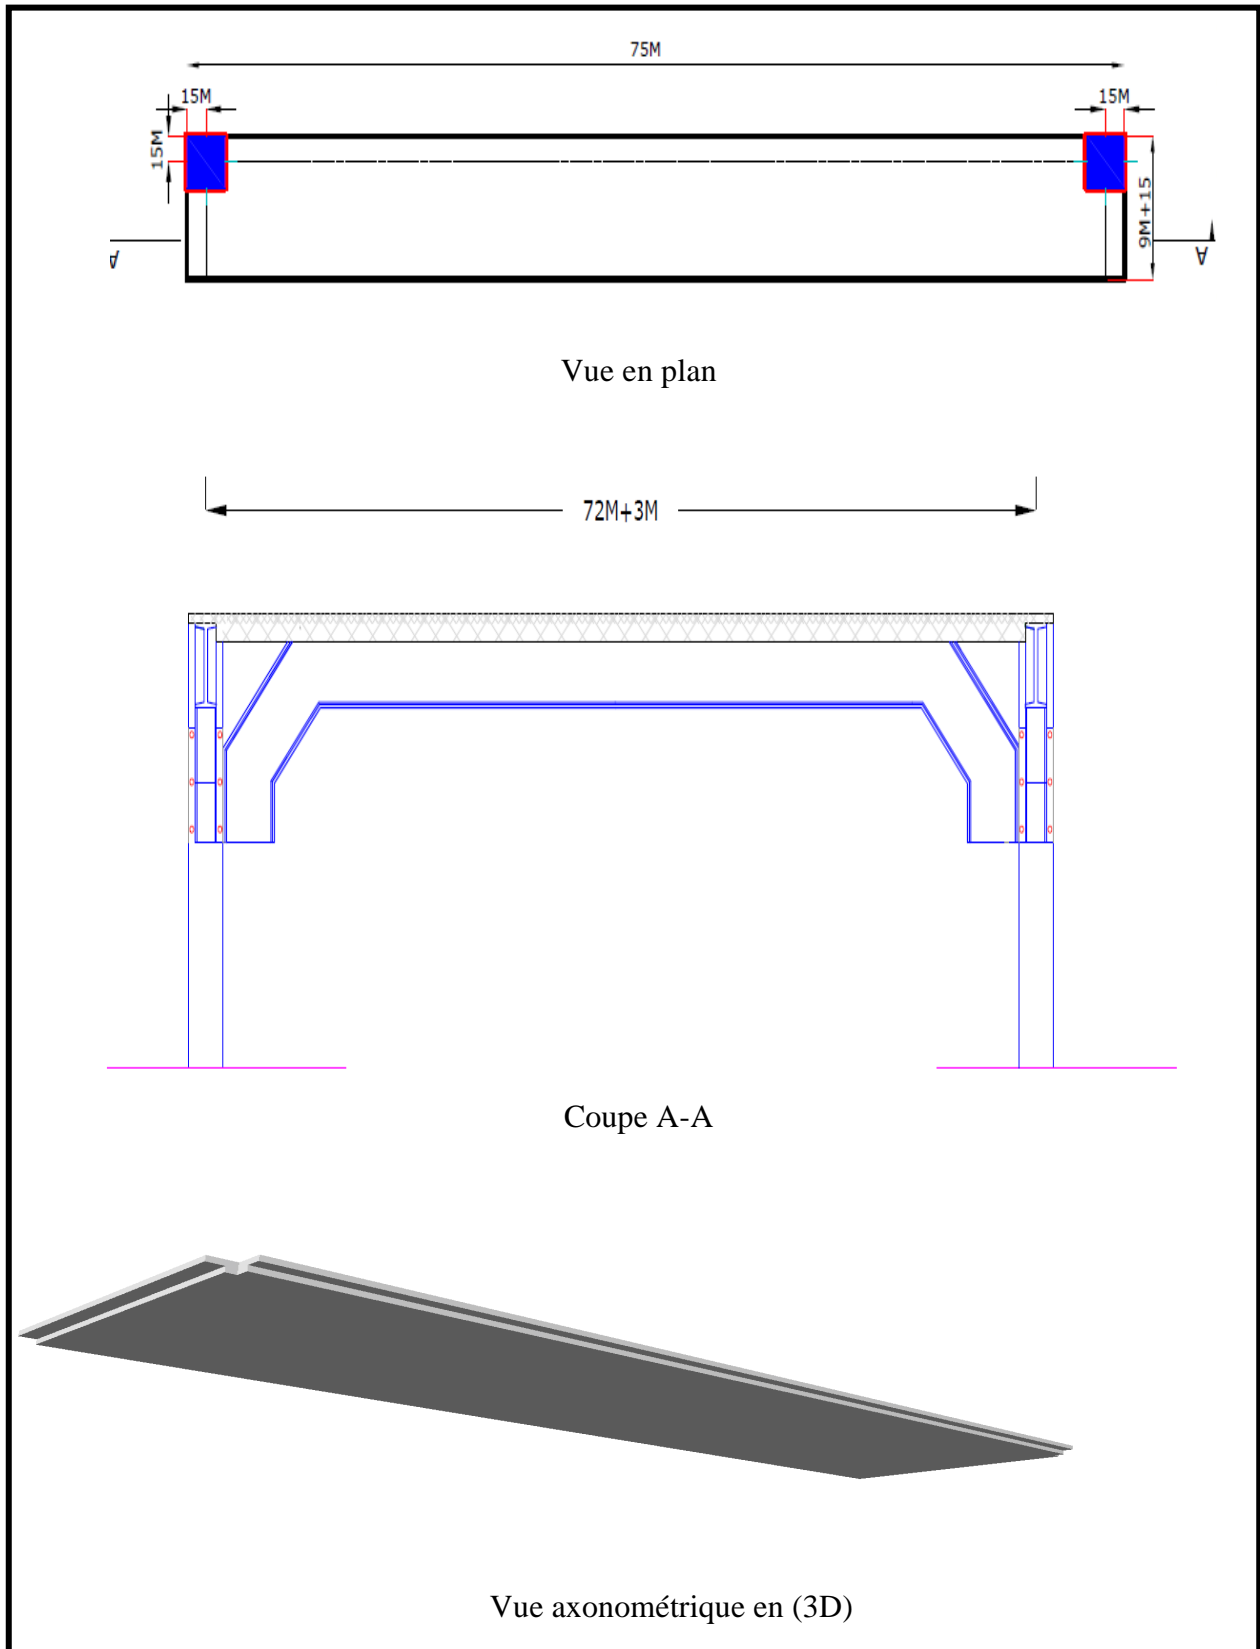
Dalle périphérique saillante de n=15 cas d'une façade dans les deux cotés latéraux
